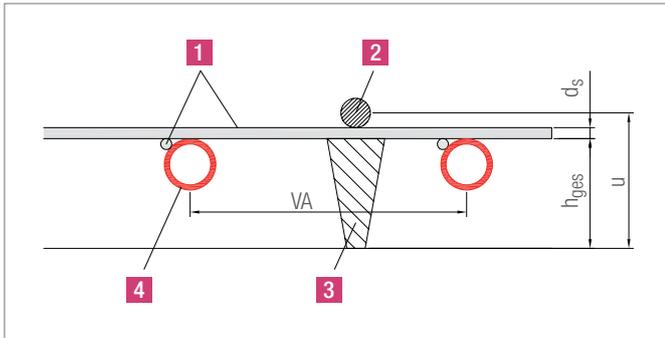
Aufbau untere Bewehrung, Schnitt (Detail)
